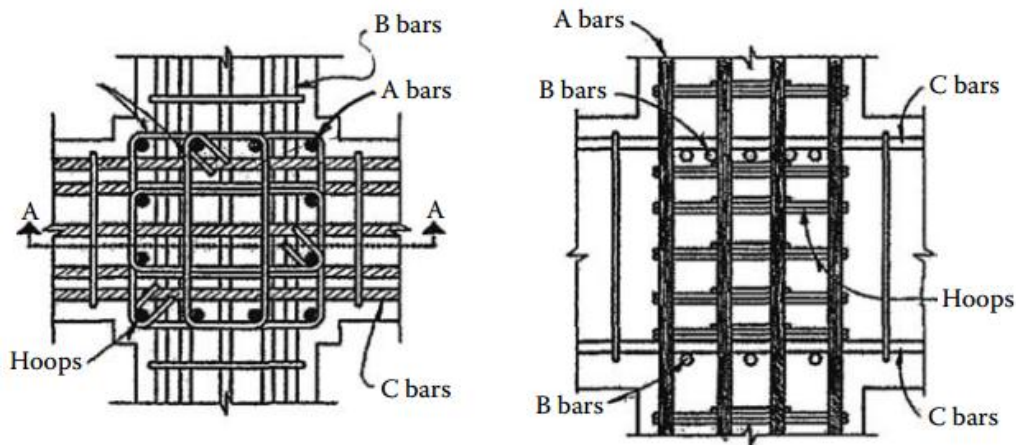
32. Bố trí cốt đai tại nút khung theo yêu cầu kháng chấn.
